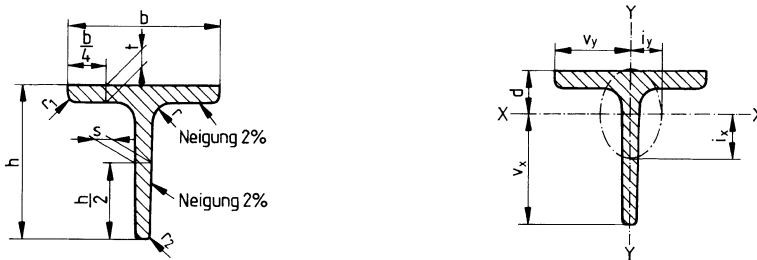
Warmgewalzter gleichschenkliger T-Stahl mit gerundeten Kanten und Übergängen
